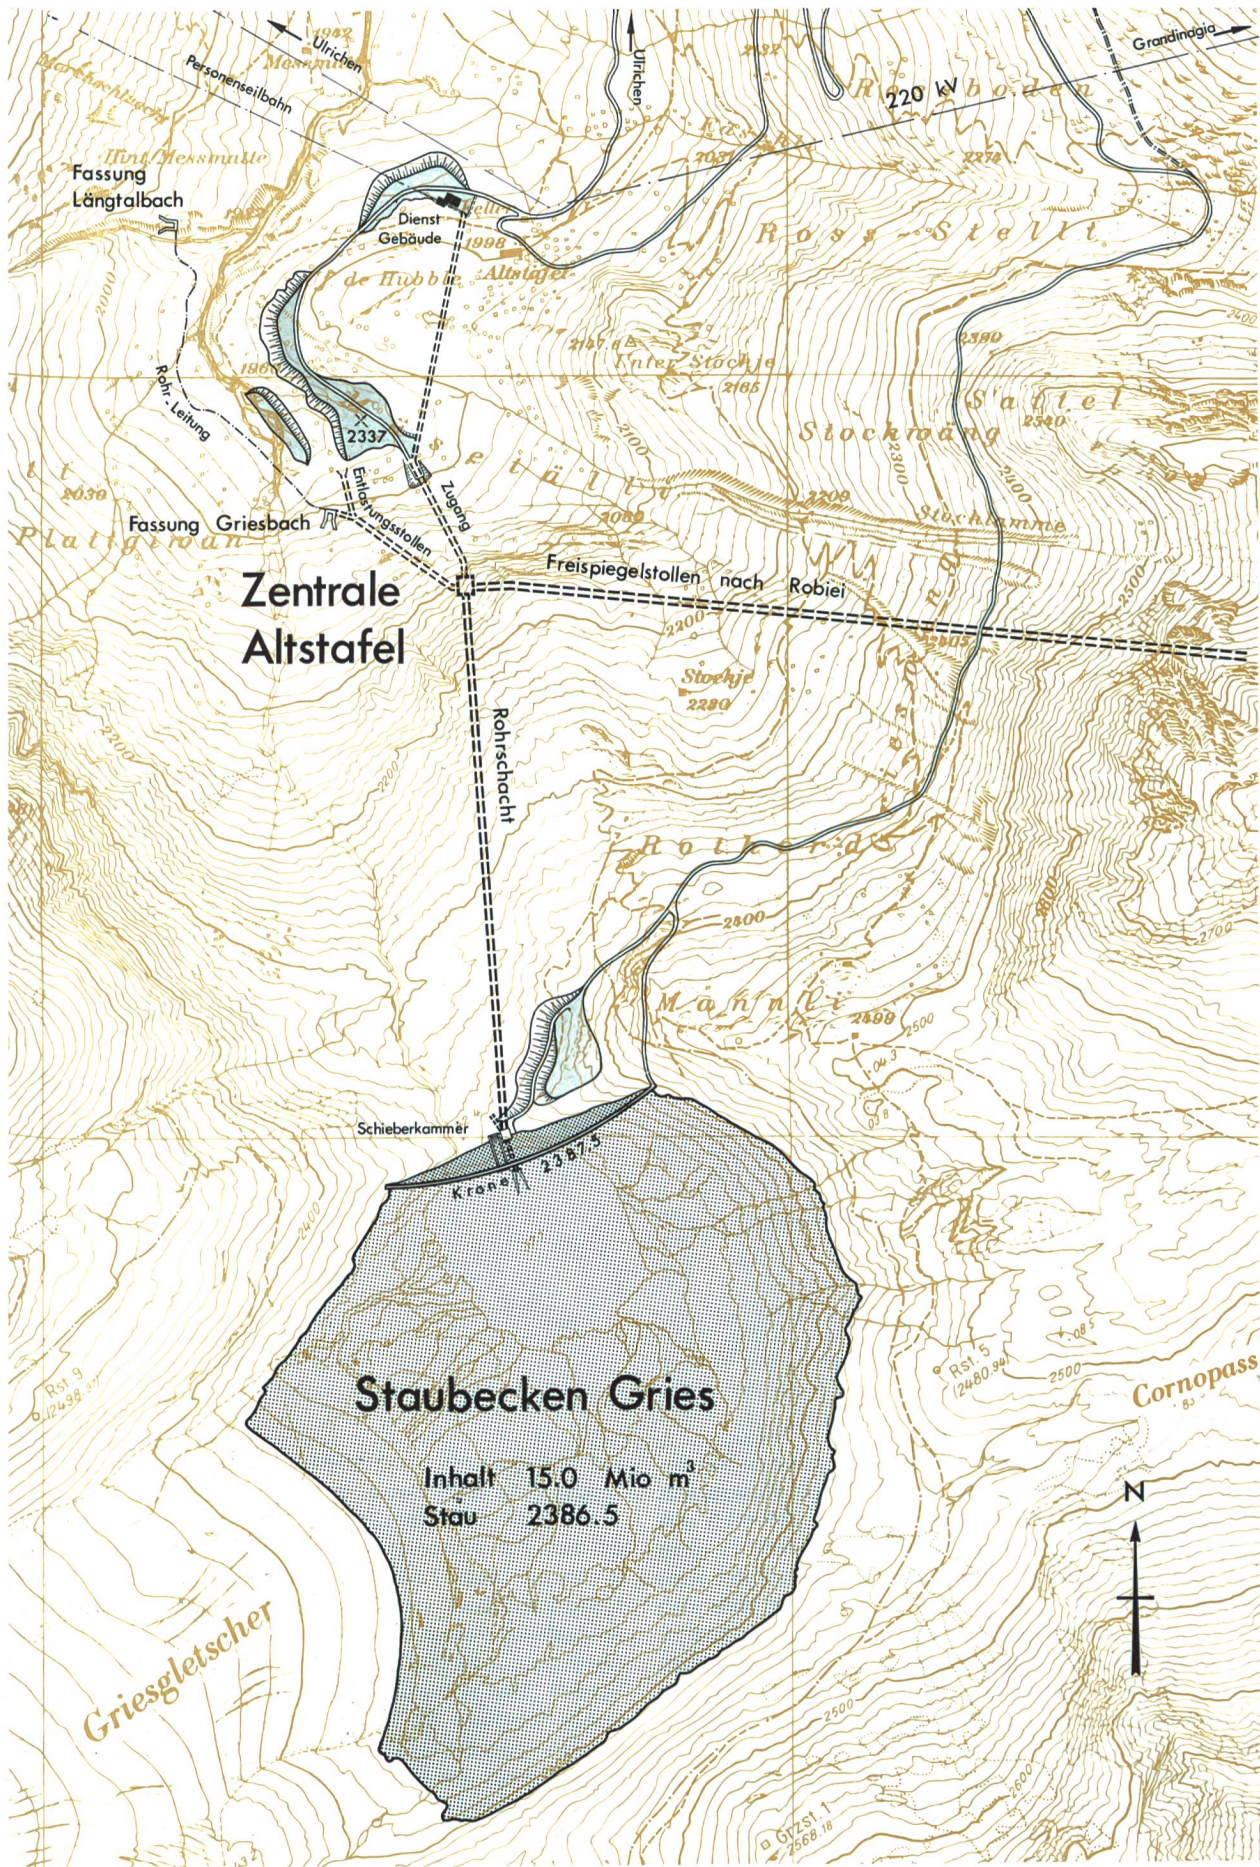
Staubecken Gries, Lageplan 1 : 10 000
